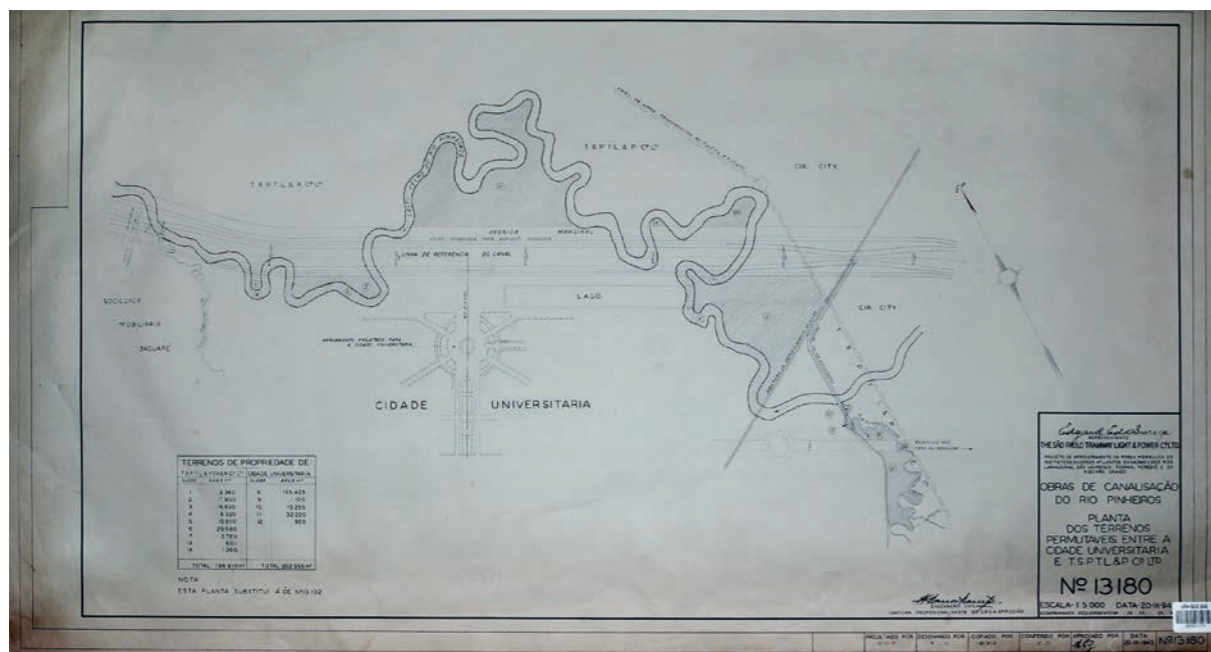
Planta parcial das obras de canalização do rio Pinheiros no trecho correspondente ao Instituto Butantan. 1937.
